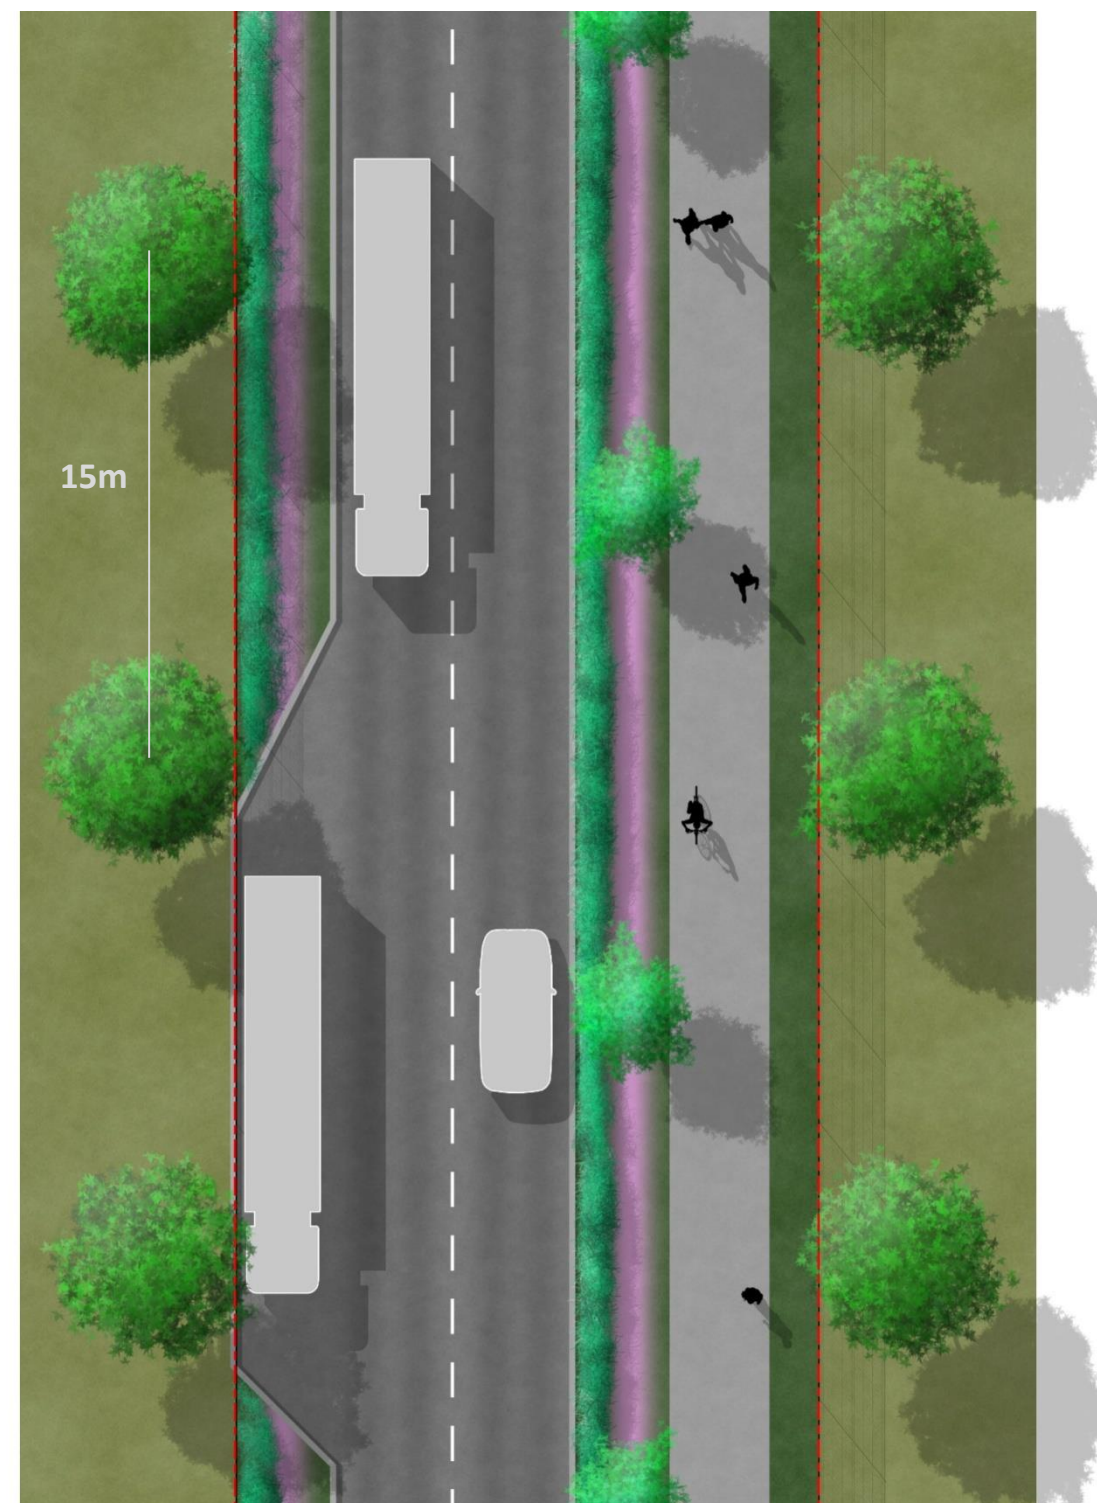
Plan de la voie de desserte de 7m sur emprise public de 17.50m
